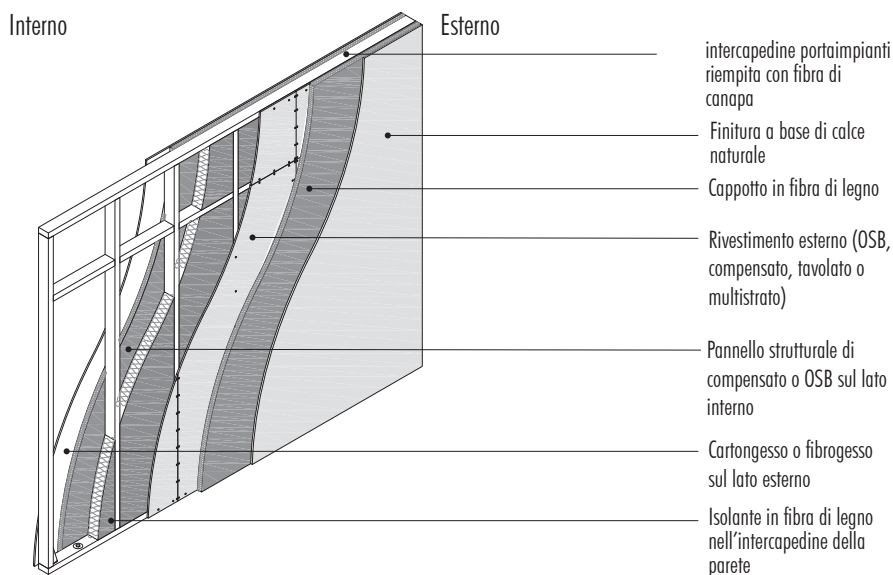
Esempio di pacchetto costruttivo completo per una parete Platform.
